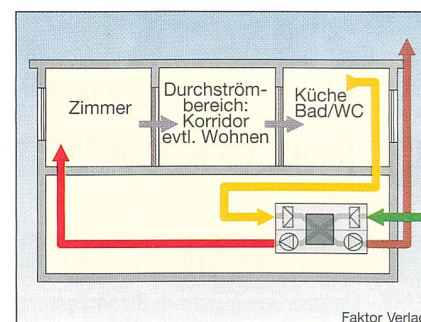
Schematische Darstellung einer einfachen Lüftungsanlage mit WRG
